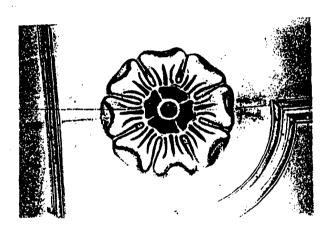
/100318 Detail hiasan platon di ruang lobby
